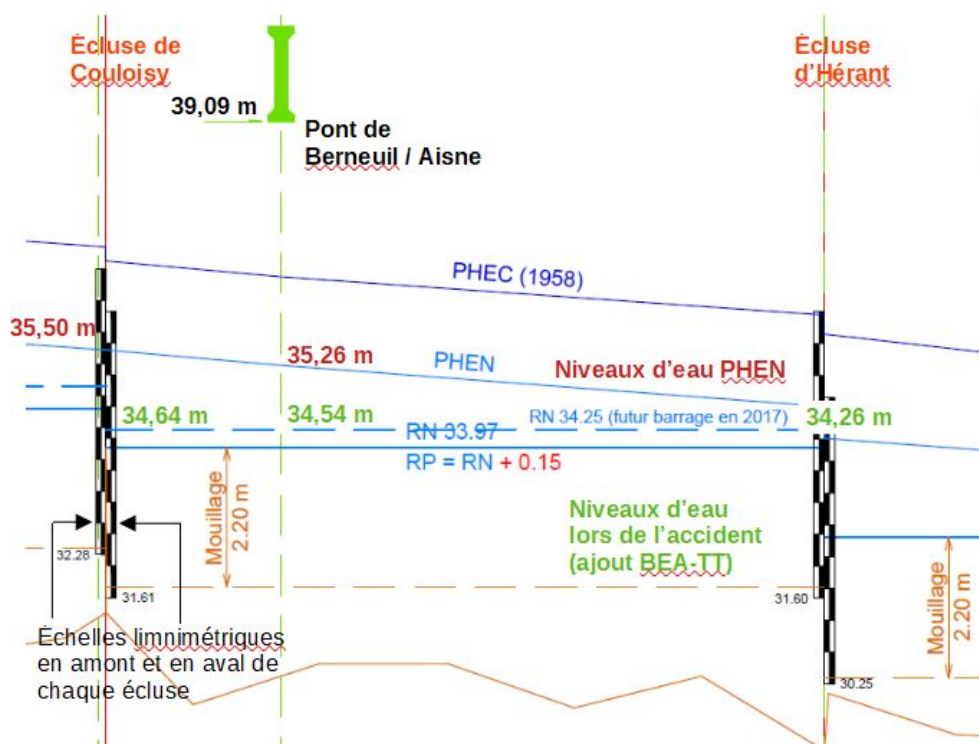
Plan du profil en long de l'Aisne entre les écluses de Couloisy et d'Hérant
